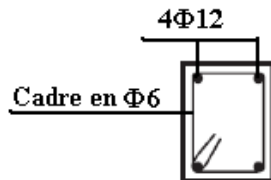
La coupe transversale (A-A) pour la poutre 1 et LMT.
